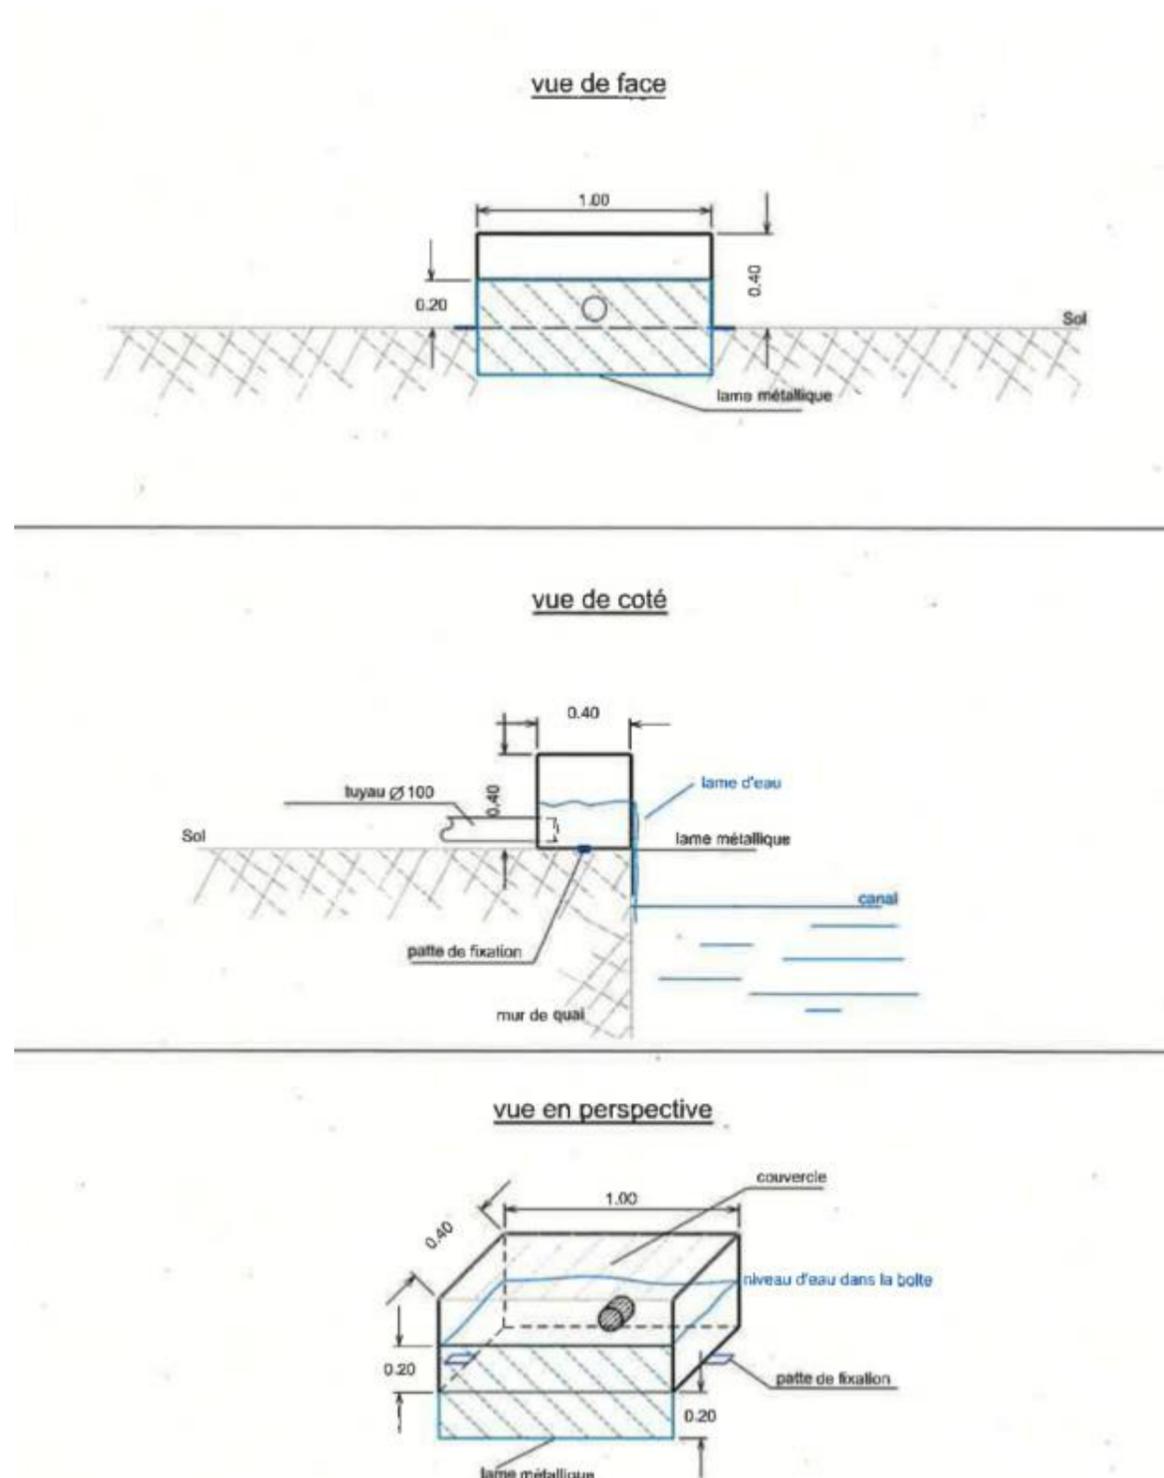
PLAN PROTOTYPE DE BOITE POUR REJET D'EAU
